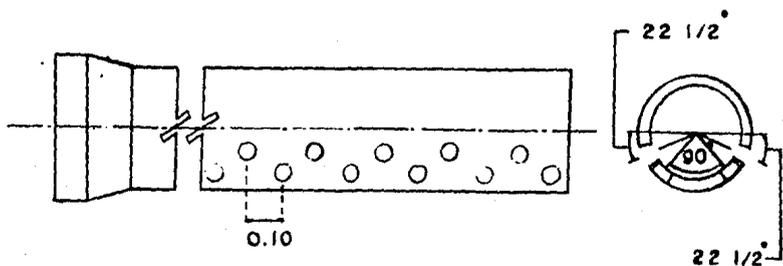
Disposición de las perforaciones en tuberías para subdrenaje.
